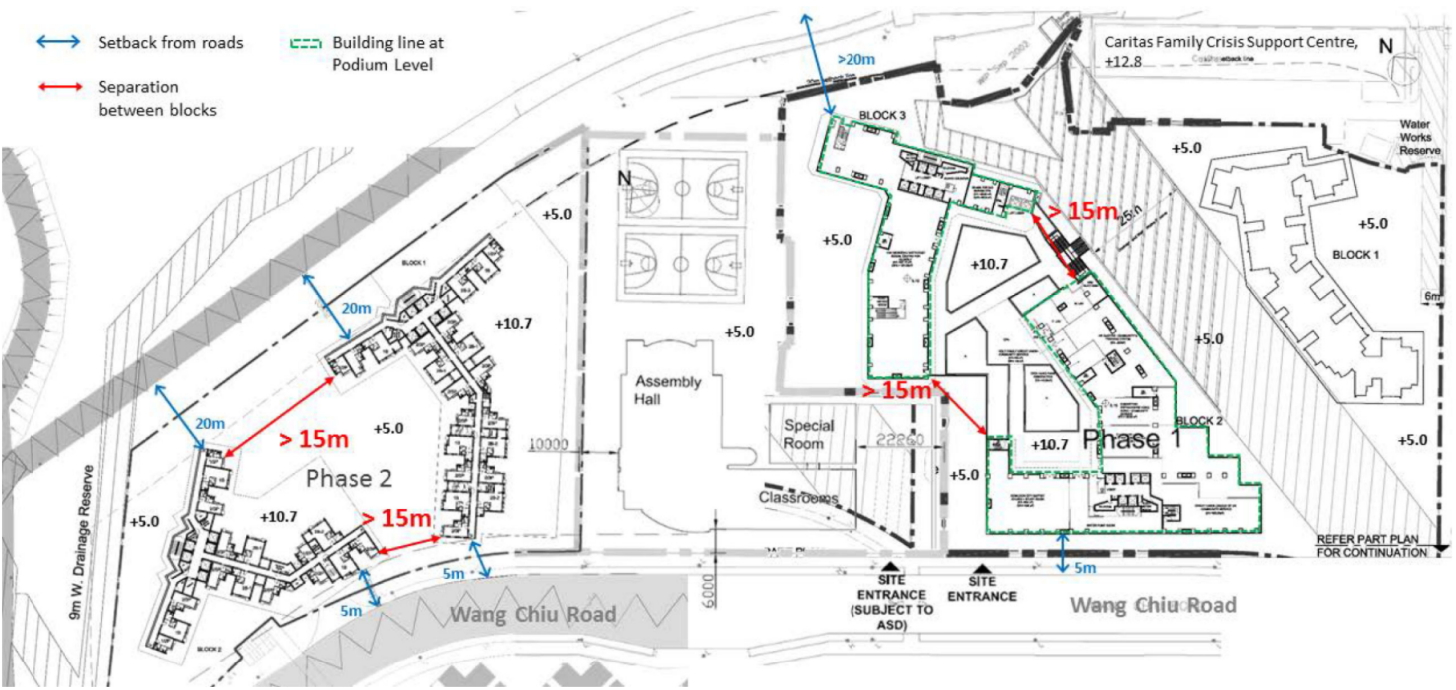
住宅大樓設計特點 Design Features at Domestic Towers
